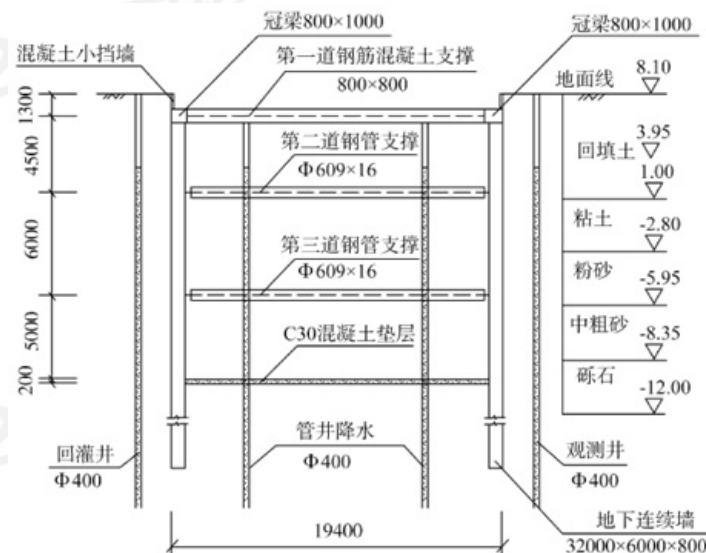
地铁站明挖施工示意图(高程单位: m; 尺寸单位: mm)
